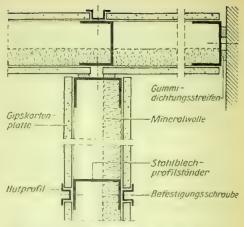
Grundriß einer Trennwand in Ständerhauweise bis 4000 mm Höhe (Stahlblechprofilständer)
